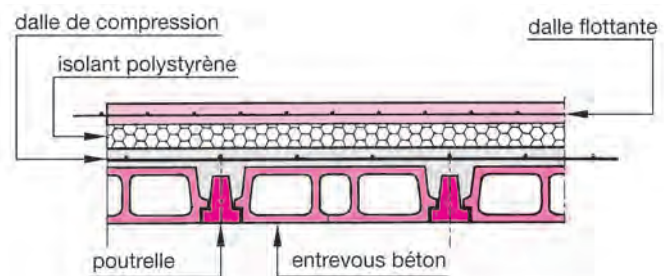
Plancher traditionnel d'étage avec dalle flottante sur isolant PSE
